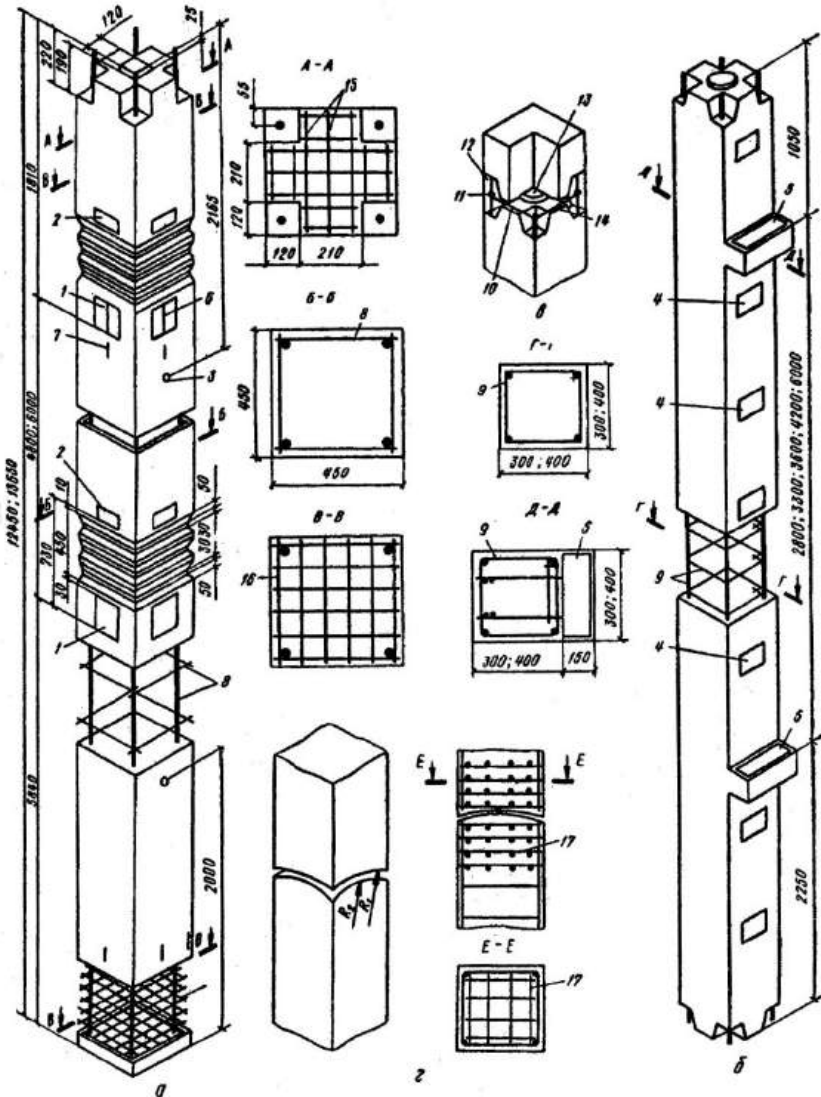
Збірні колони багатопверхових будівель: *а* – з безбалковими перекриттями; *б* – із в'язевим каркасом; *в* – жорсткий стик колон із ванним зварюванням чотирьох робочих стержнів; *г* – шарнірний стик колон; *1...5* – закладні деталі; *6* – риска, що фіксує вісь закладної деталі; *7* – риски геометричних осей; *8,9* – арматурні каркаси; *10* – цементний розчин; *11* – ванне зварювання; *12* – бетон замонолічування; *13* – центральний бетонний виступ; *14* – додатковий хомут; *15...17* – сітки непрямого армування
